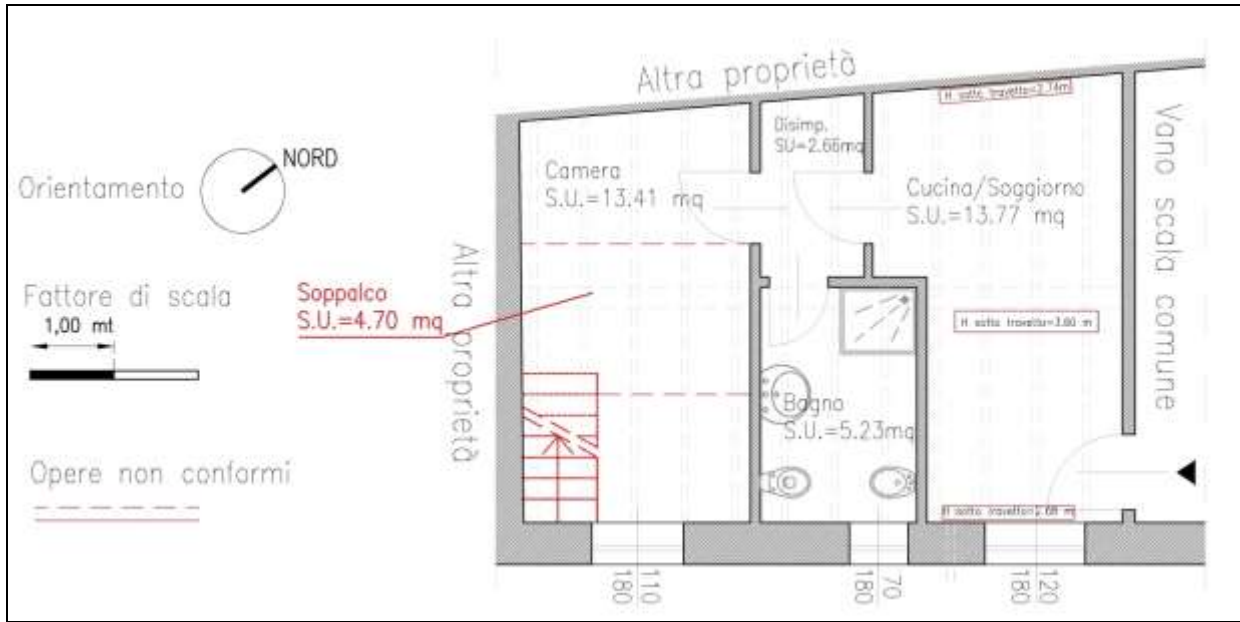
Pianta di confronto dell'immobile oggetto di perizia con ultima pratica edilizia approvata
